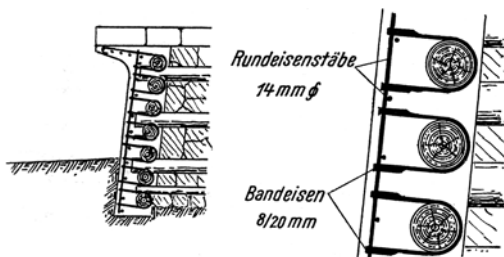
Verkleidung von Holzsperrren mit Eisenbetonwänden.
